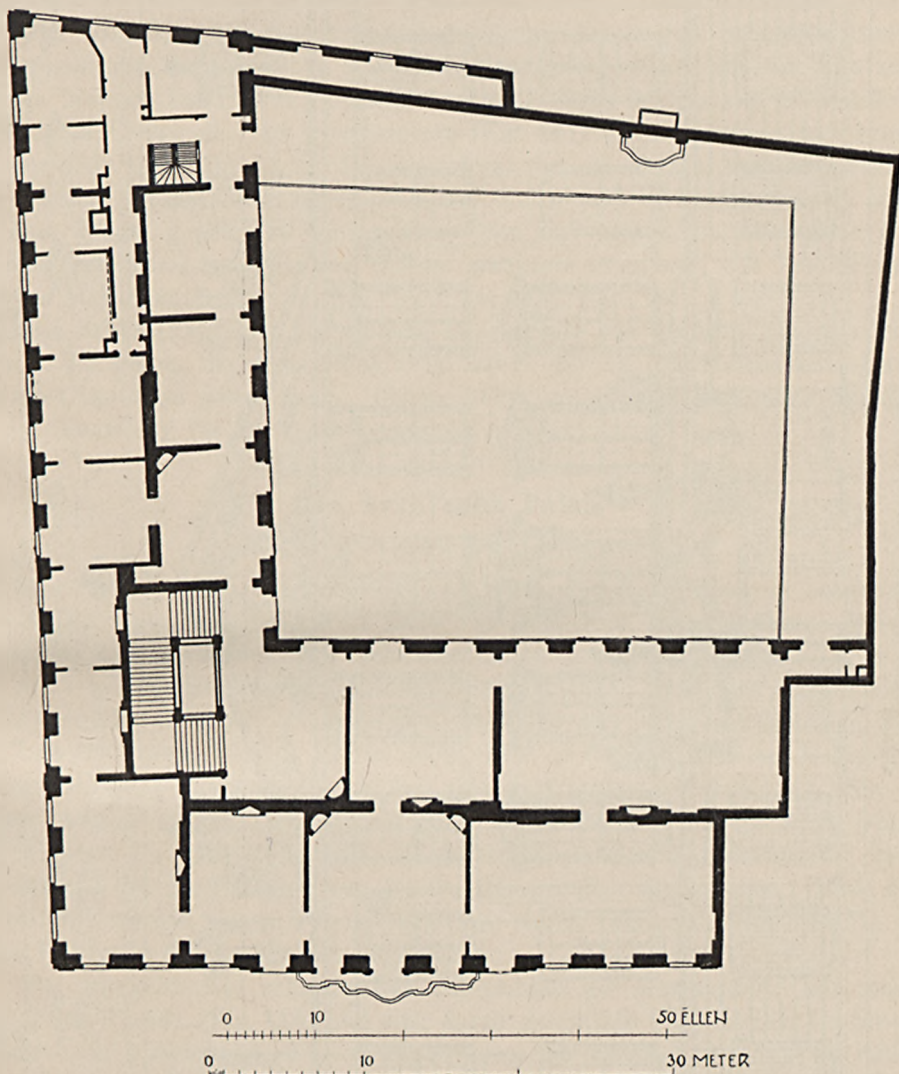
Rutowsky'sches Palais, Grundriss des Hauptgeschosses.
